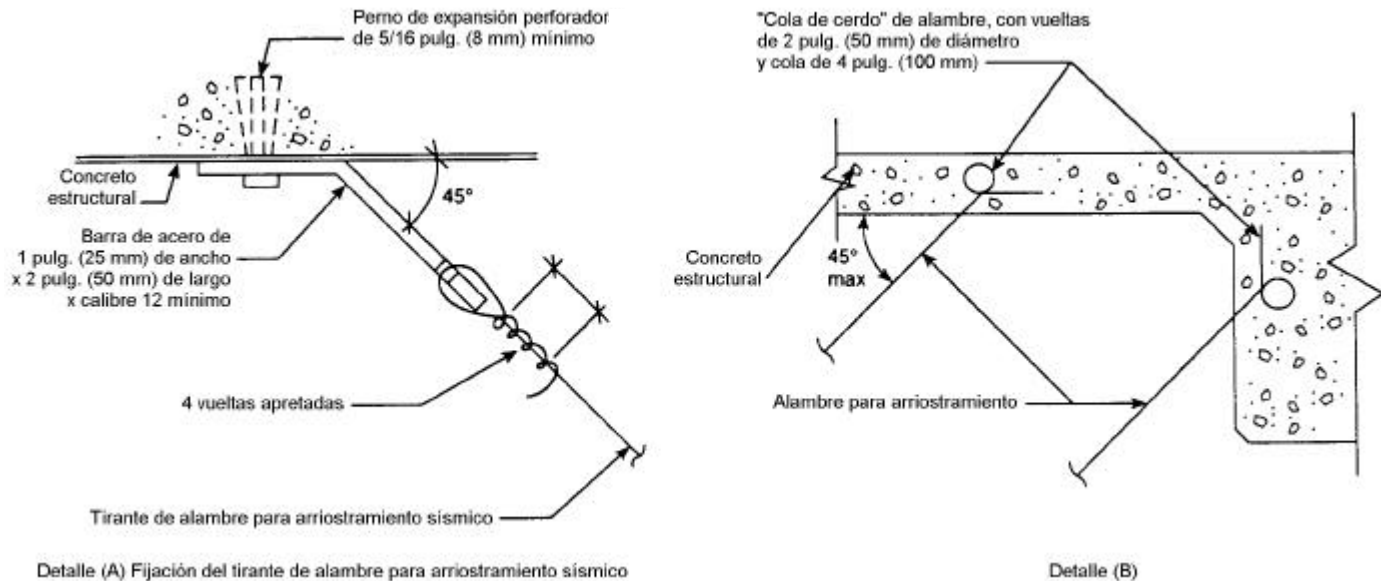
(a) Fijación de Alambre a concreto moldeado in situ.
